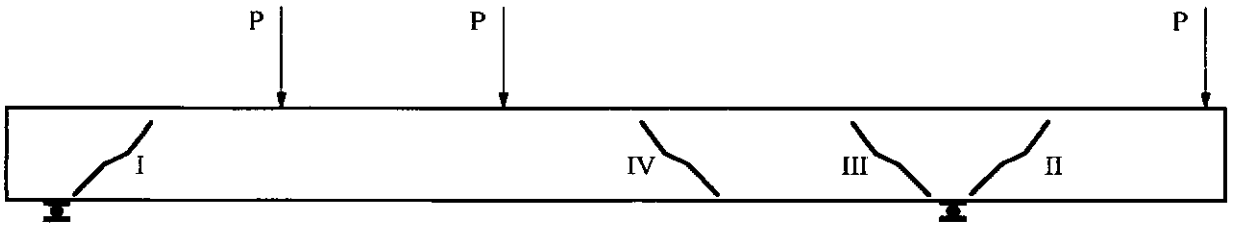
Esquema de carga das vigas e regiões de fissuração de cortante [17]
